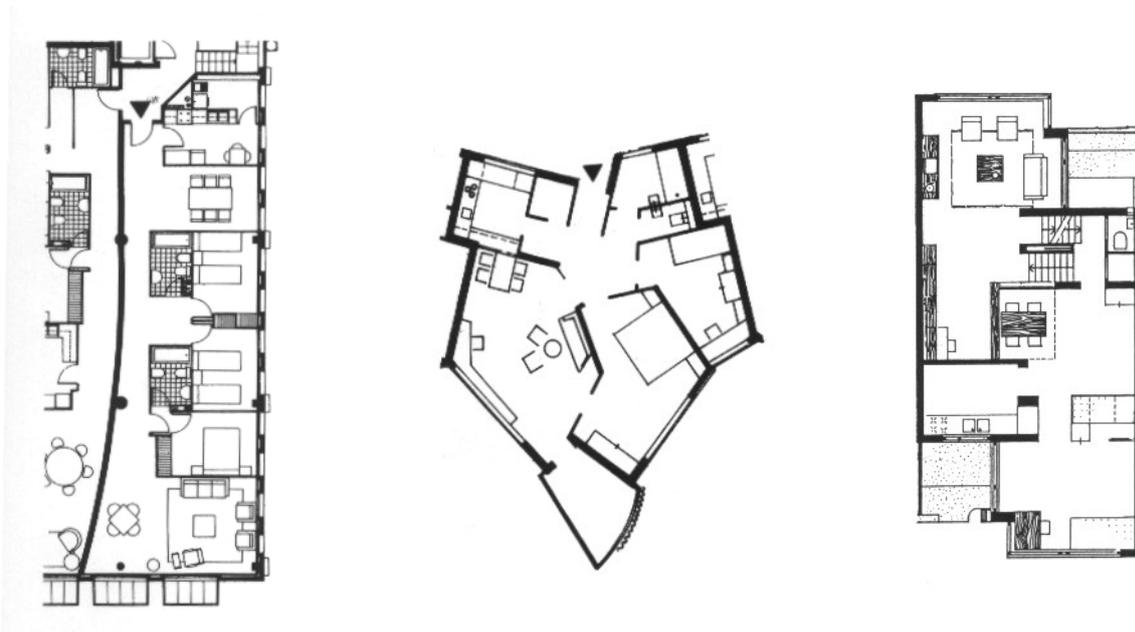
Exemplo de diferentes modos de distribuição das habitações – planta em corredor, planta orgânica e planta fluida [Fonte: SCHNEIDER, 1998]
